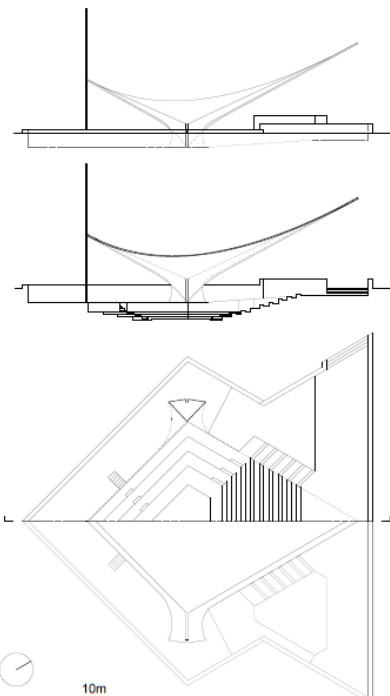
Planta, alzado y sección del Oratorio dibujados a partir de la información del proyecto original, 2011. Dibujo del autor.
